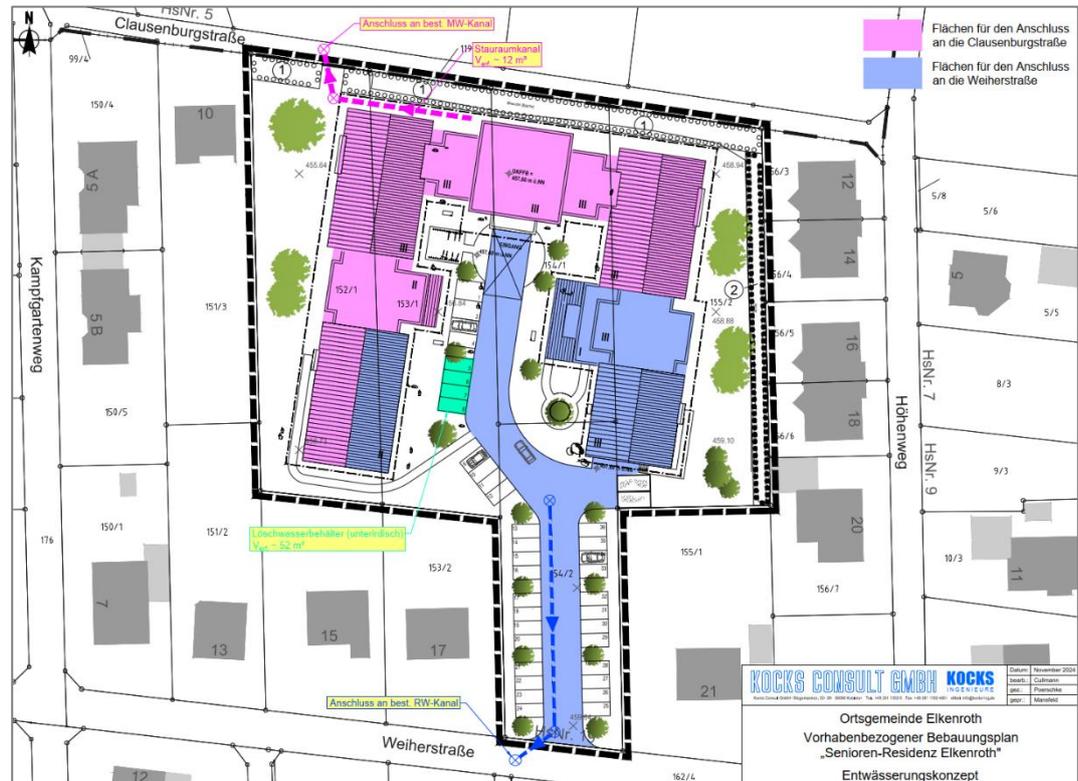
Lageplan zum Entwässerungskonzept, unmaßstäblich
